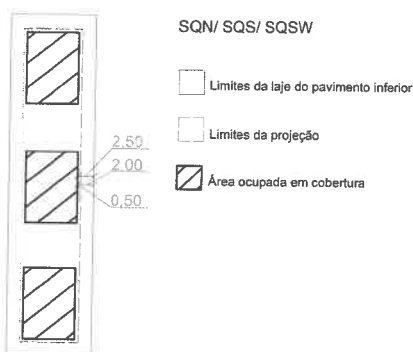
Planta esquemática da ocupação de cobertura nas superquadras da Asa Norte, da Asa Sul e do Setor Sudoeste (SQN, SQS, SQSW)
